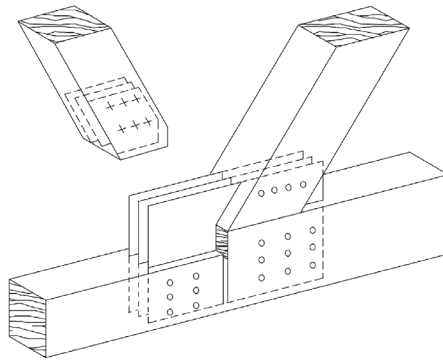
Узел фермы с гвоздевым соединением элементов при помощи накладок
